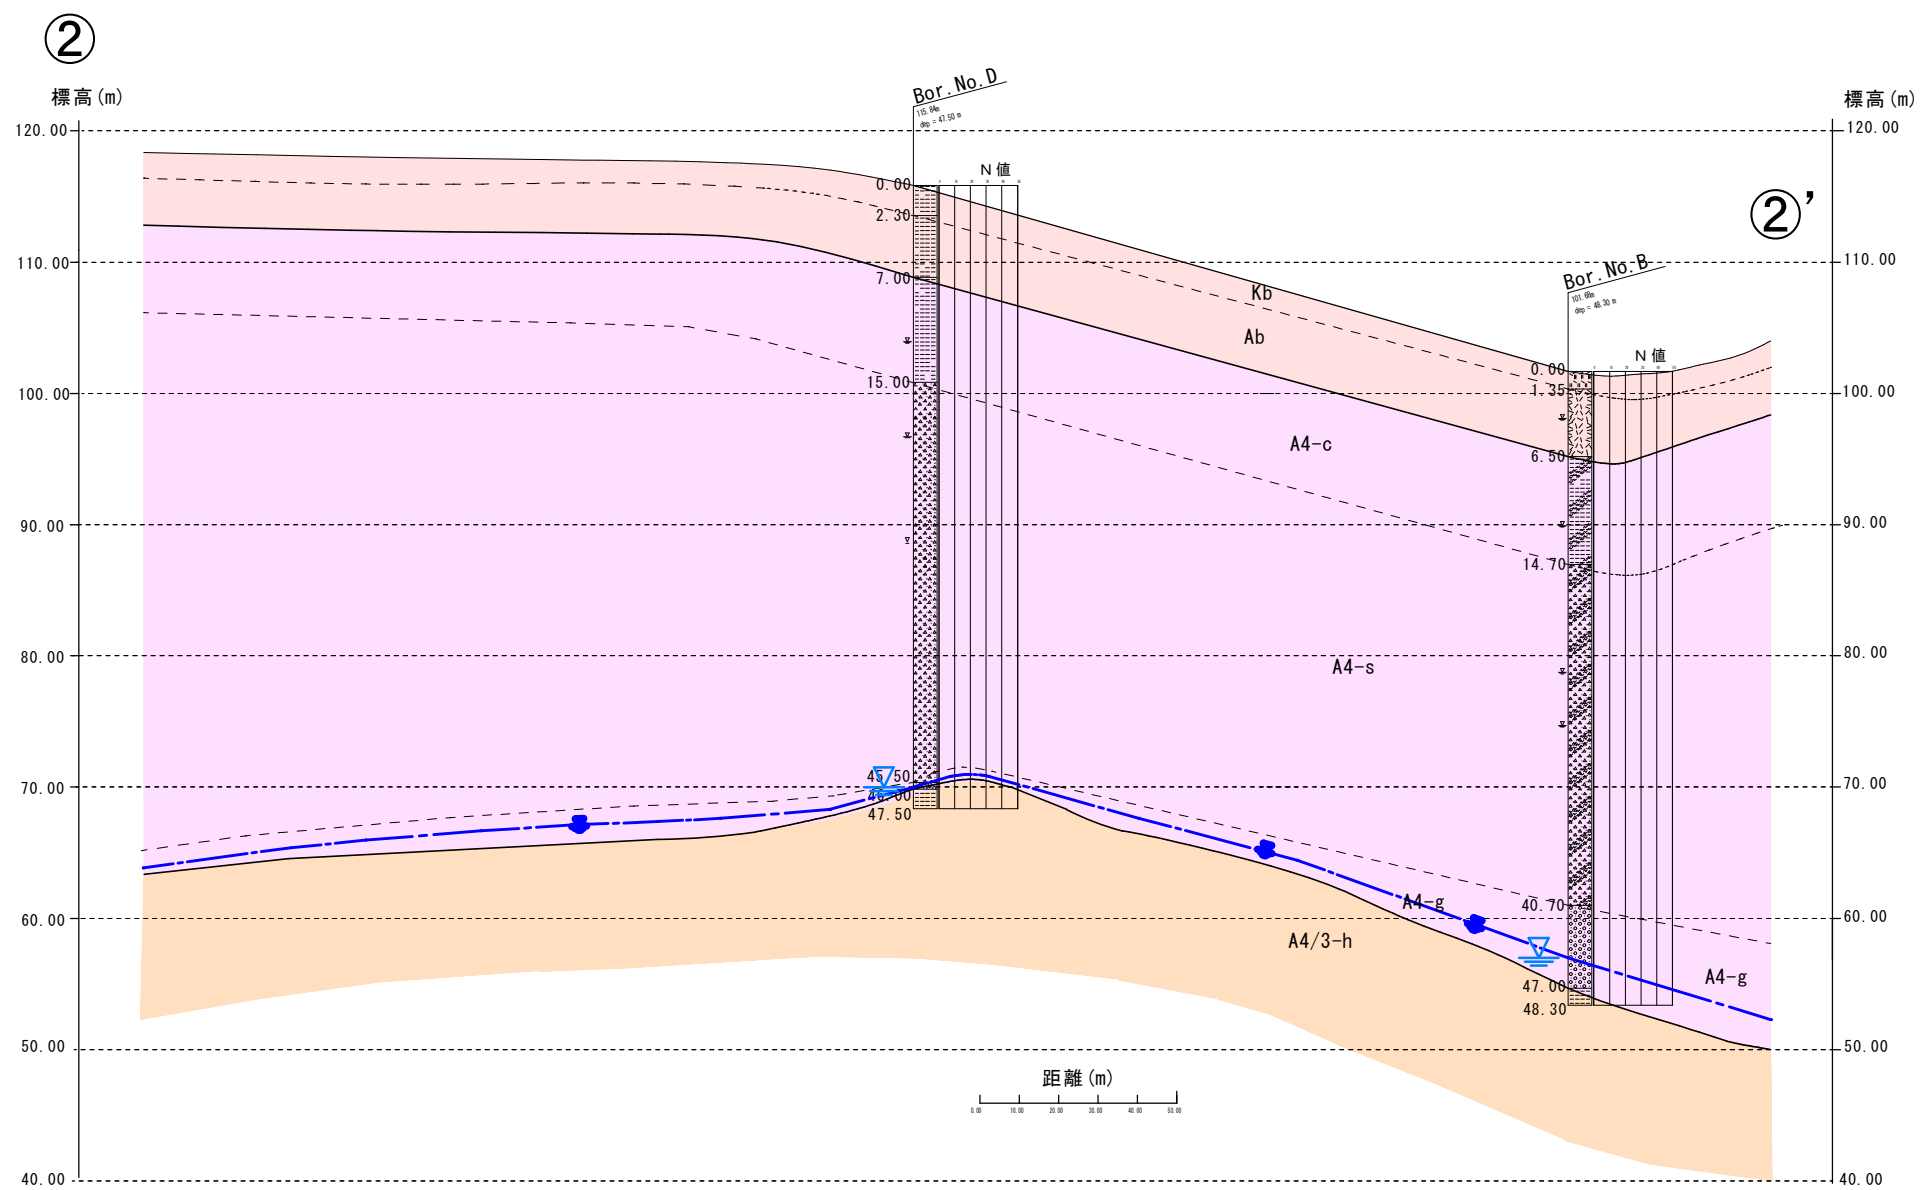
②-②' 地質断面図 (No. D~No. B断面)
